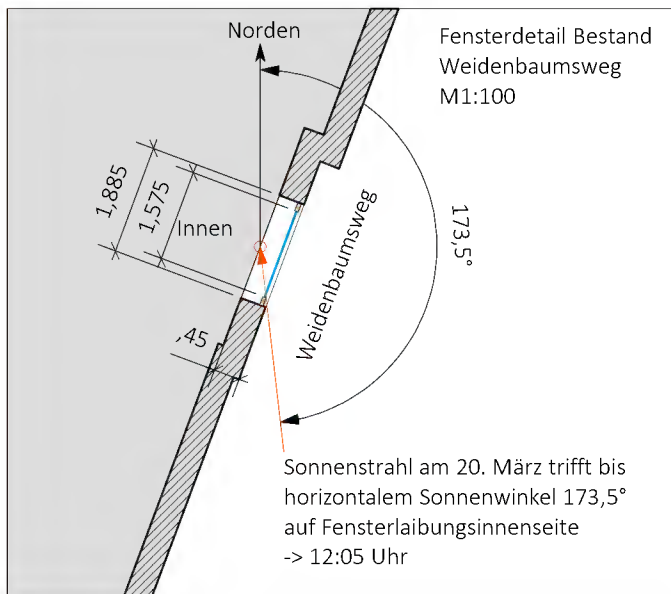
Fensterdetail - Weidenbaumsweg 136-110
